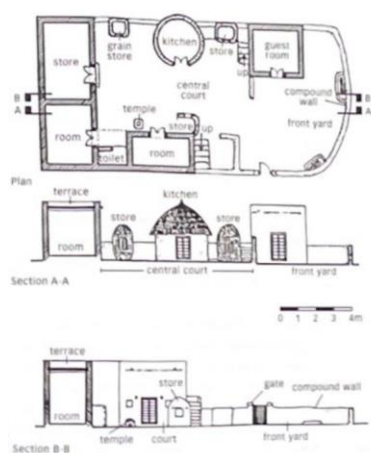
Grundriss und Schnitt eines Bikaner-Familienkomplex (links) (Quelle: Oliver, 1997, S. 945)
